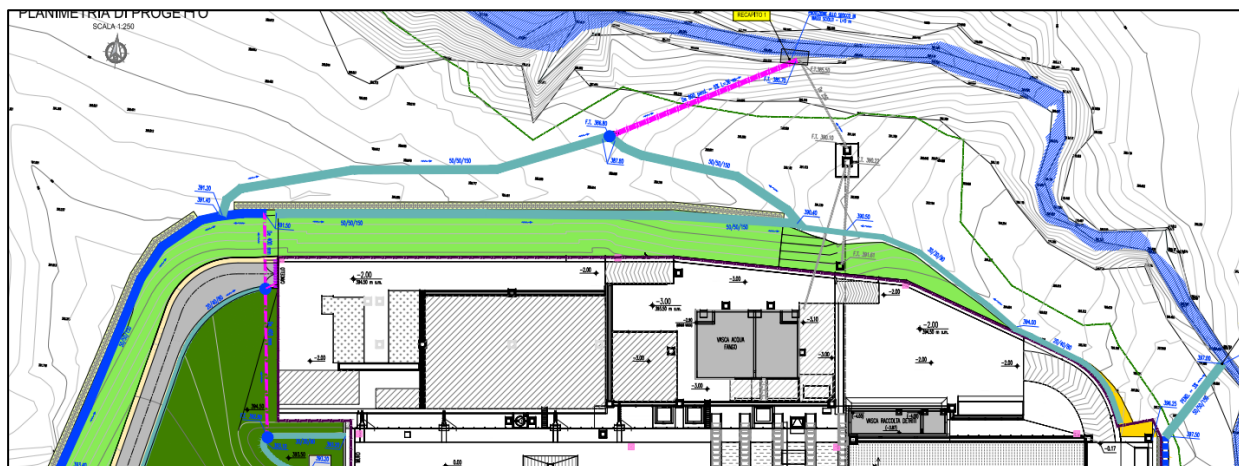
Planimetria di progetto della rete idraulica di intercettazione ed allontanamento delle acque esterne alla postazione (stralcio fossi in terra alla base dei rilevati di stazione, lato nord).
